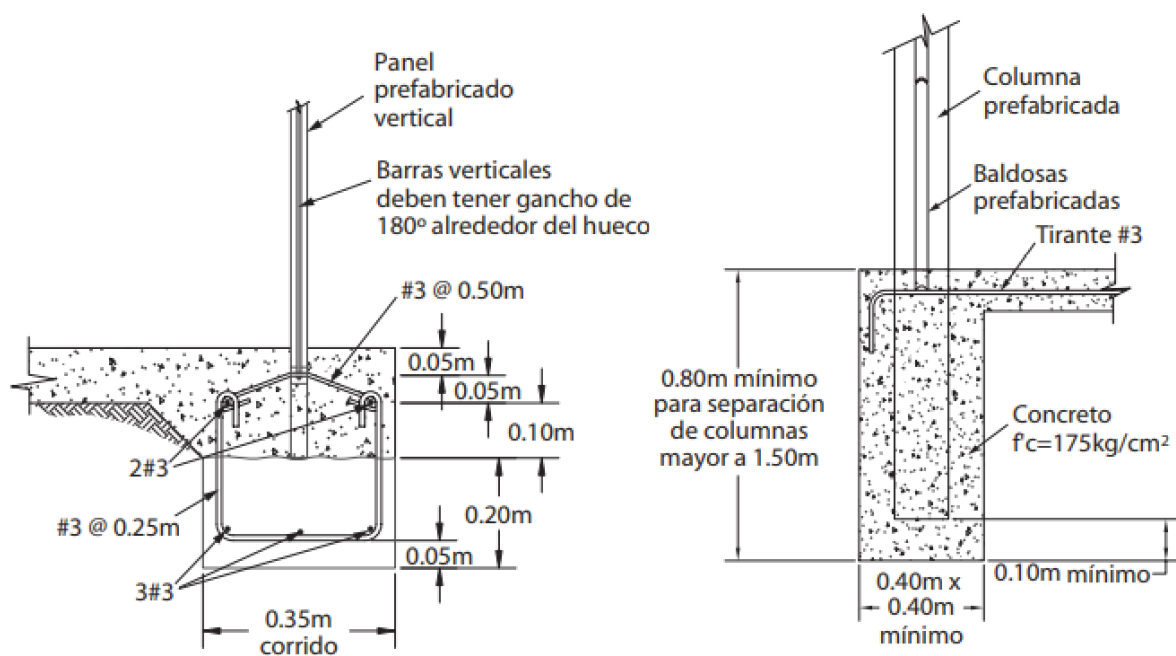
Detalles de fundación para baldosas horizontales y verticales
